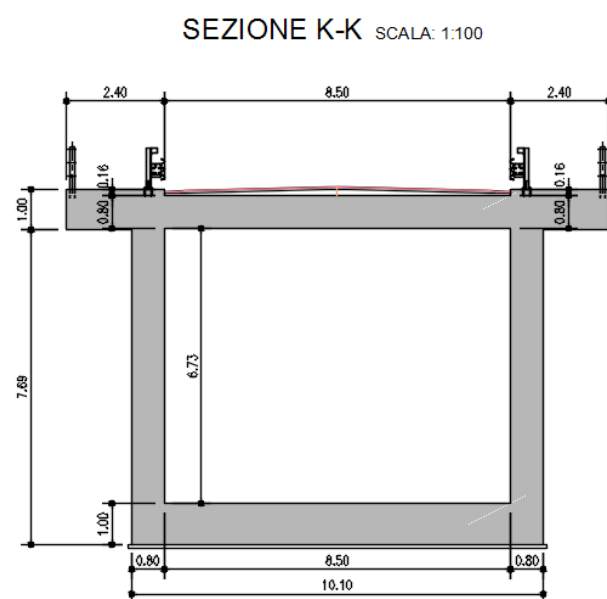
sezione tipo di scatolare con elevazione maggiore
